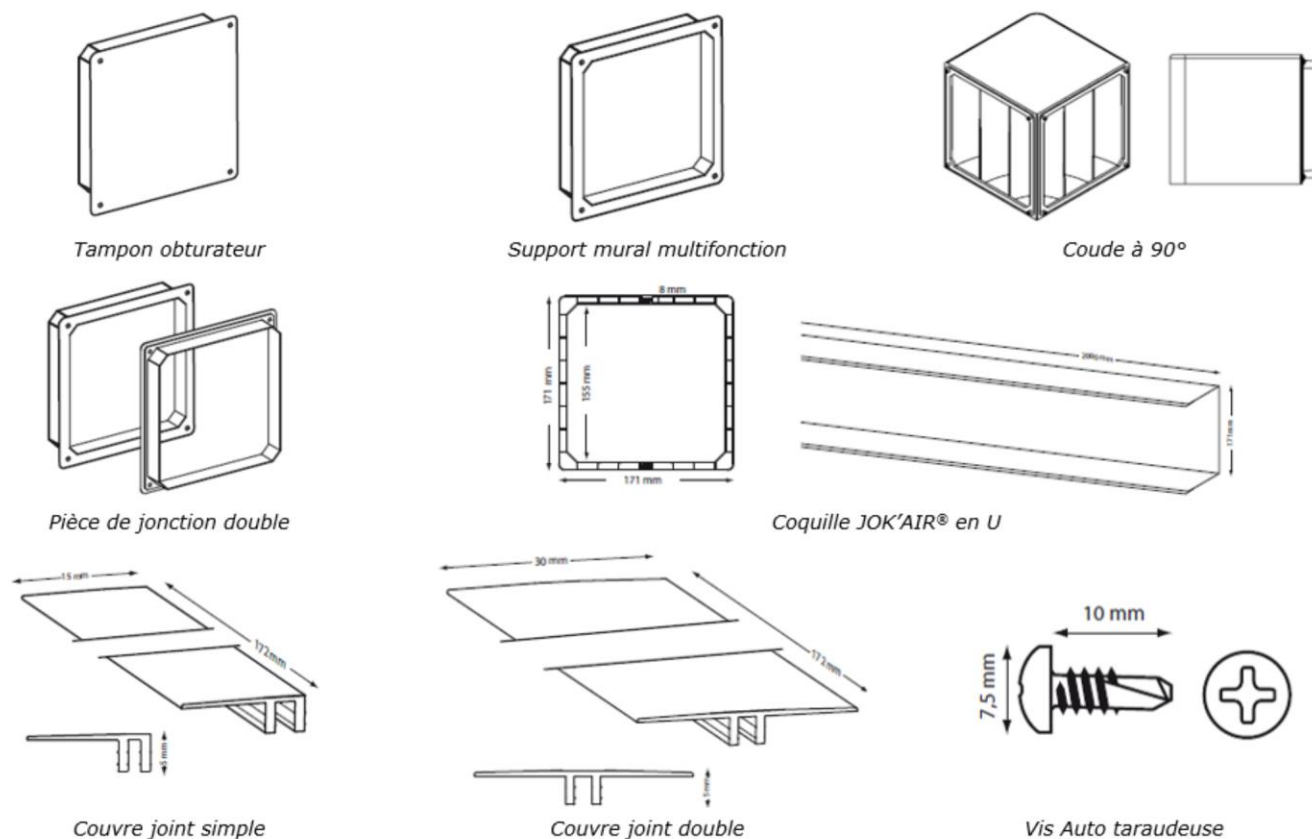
Conduits horizontaux JOK'AIR – Eléments constitutifs
